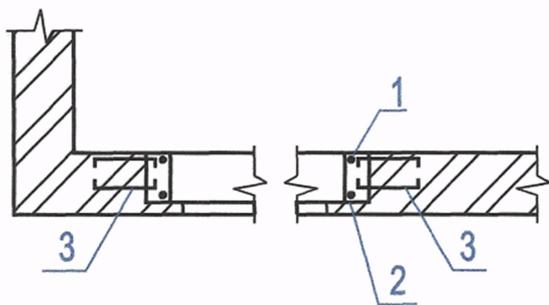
Усиление проема железобетонной рамкой:
